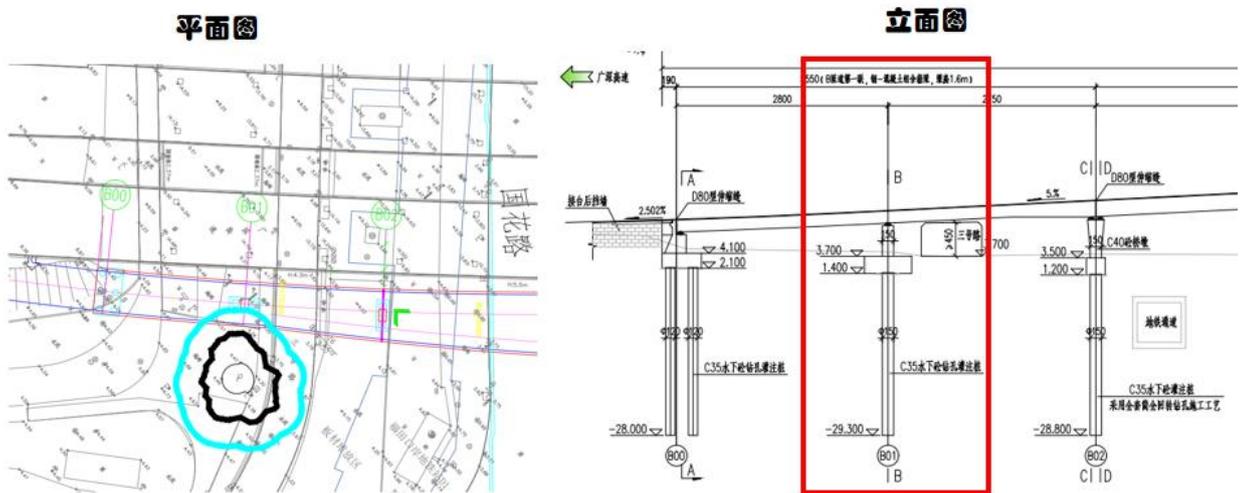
B匝道桥桥型布置图（平面图、立面图）
